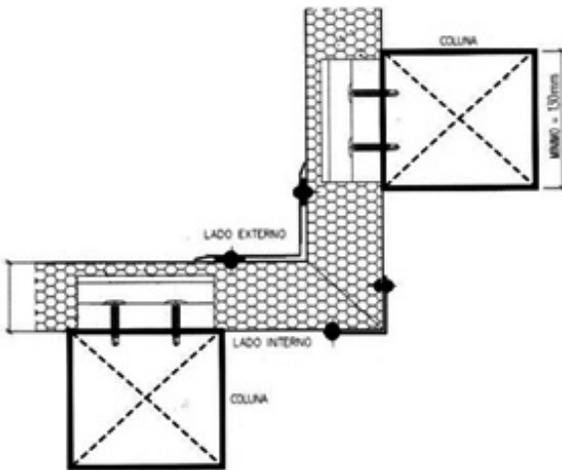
Detalhe de corte em planta da união de painéis adjacentes e da fixação do perfil de união lateral. (DÂNICA, 2013a)
